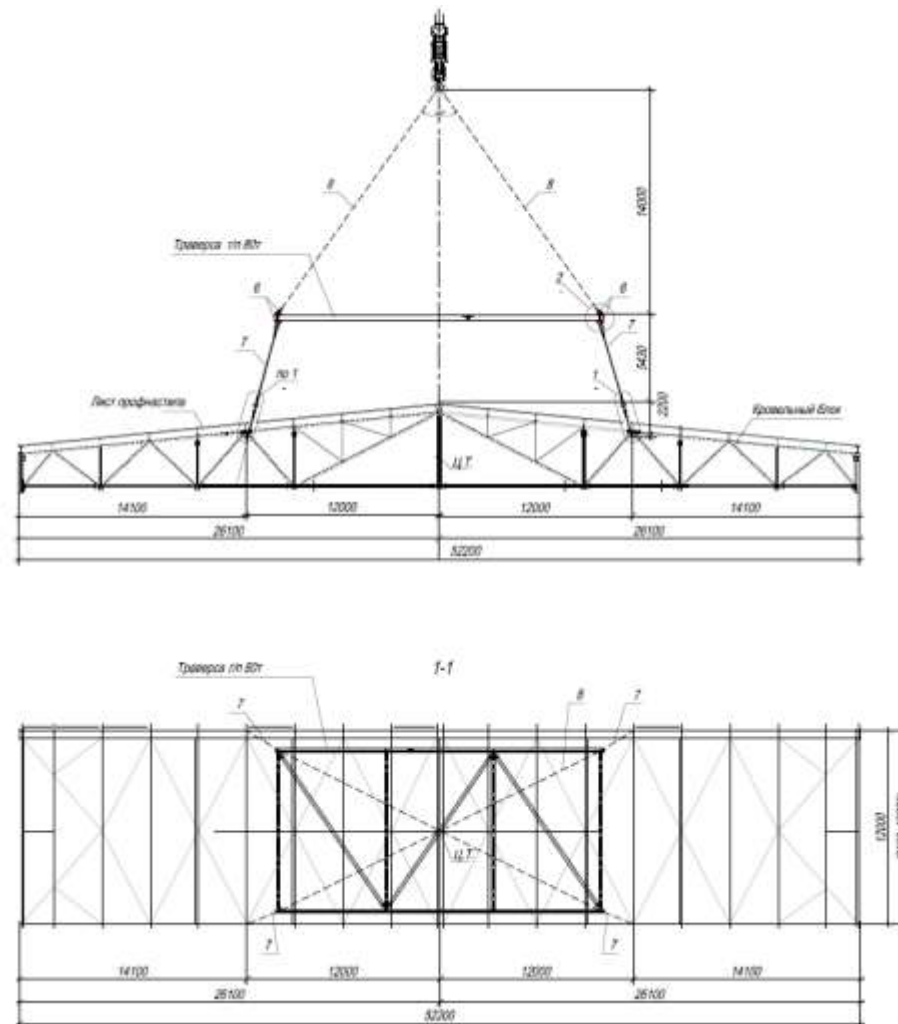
Схема строповки укрупненного блока стальных строительных конструкций кровельного покрытия здания турбины
